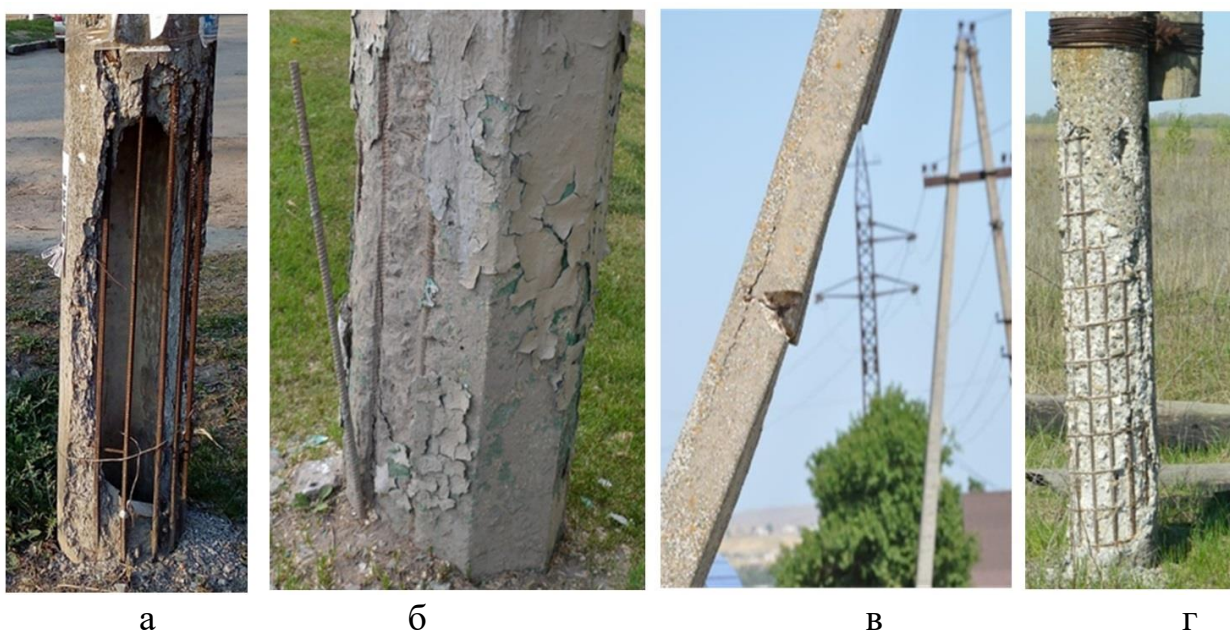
Дефекты железобетонных опор ЛЭП, расположенные до 1,5 м от уровня земли: а) разрушение железобетонного пасынка с оголением и последующей коррозией арматуры каркаса опоры ЛЭП; б) коррозия бетона опоры ЛЭП с оголением продольной арматуры; в) продольные трещины, выбоины подкоса столба ЛЭП; г) разрушение бетона опоры ЛЭП кольцевого сечения.
